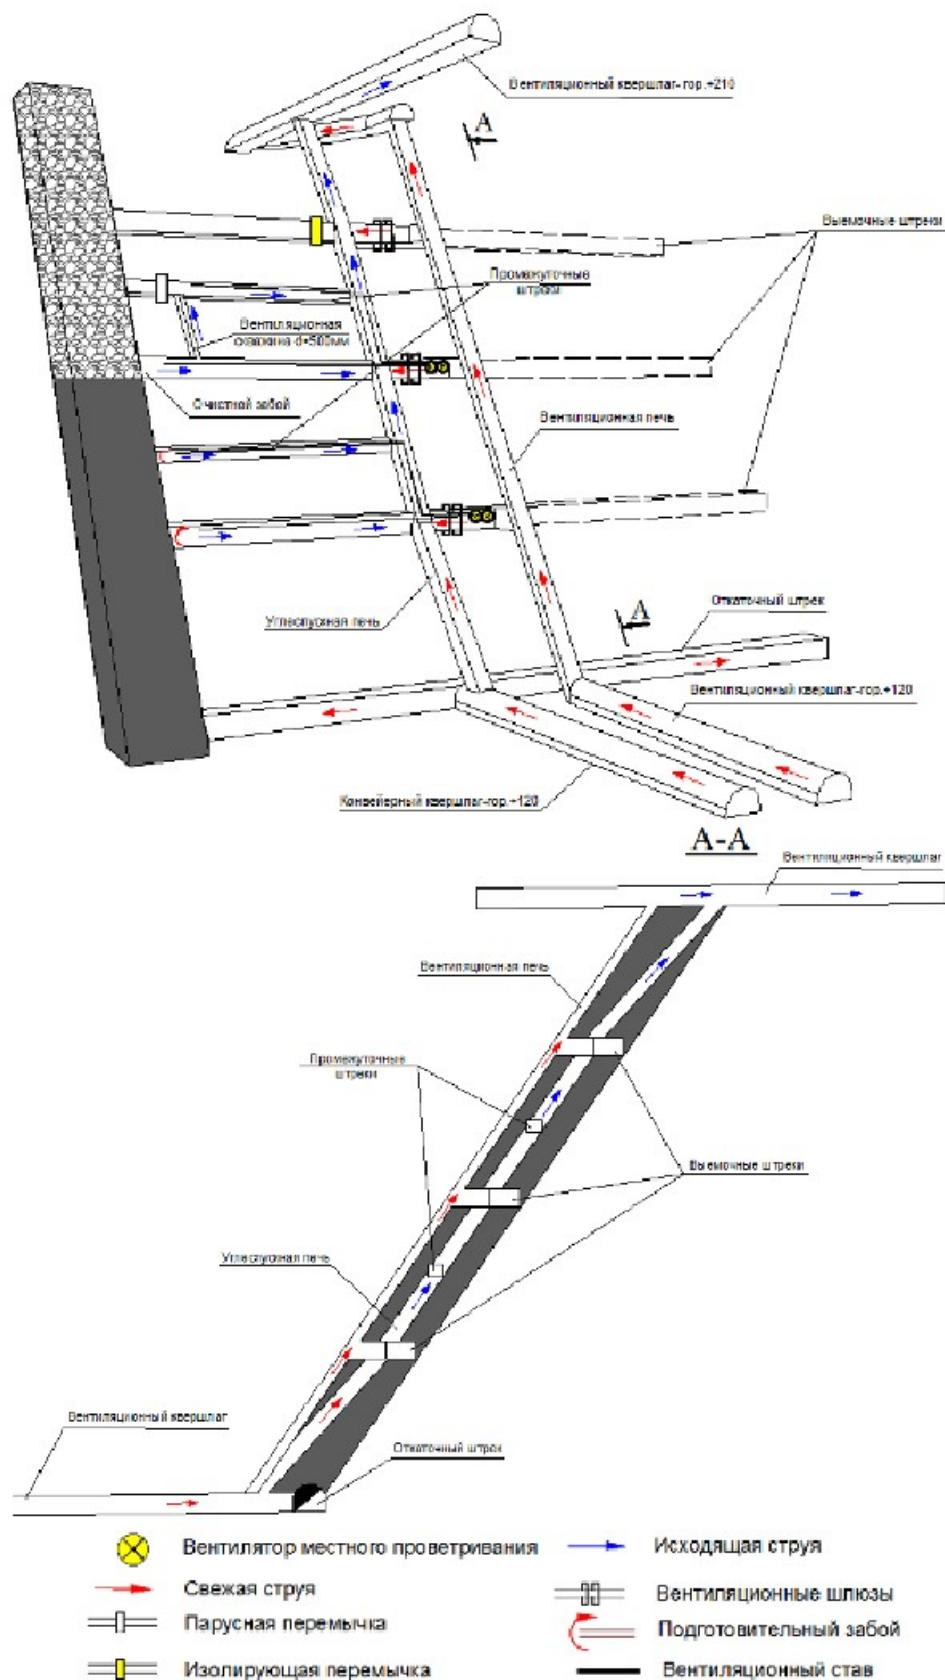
Схема вентиляции для отработки мощного крутого пласта подэтаж
